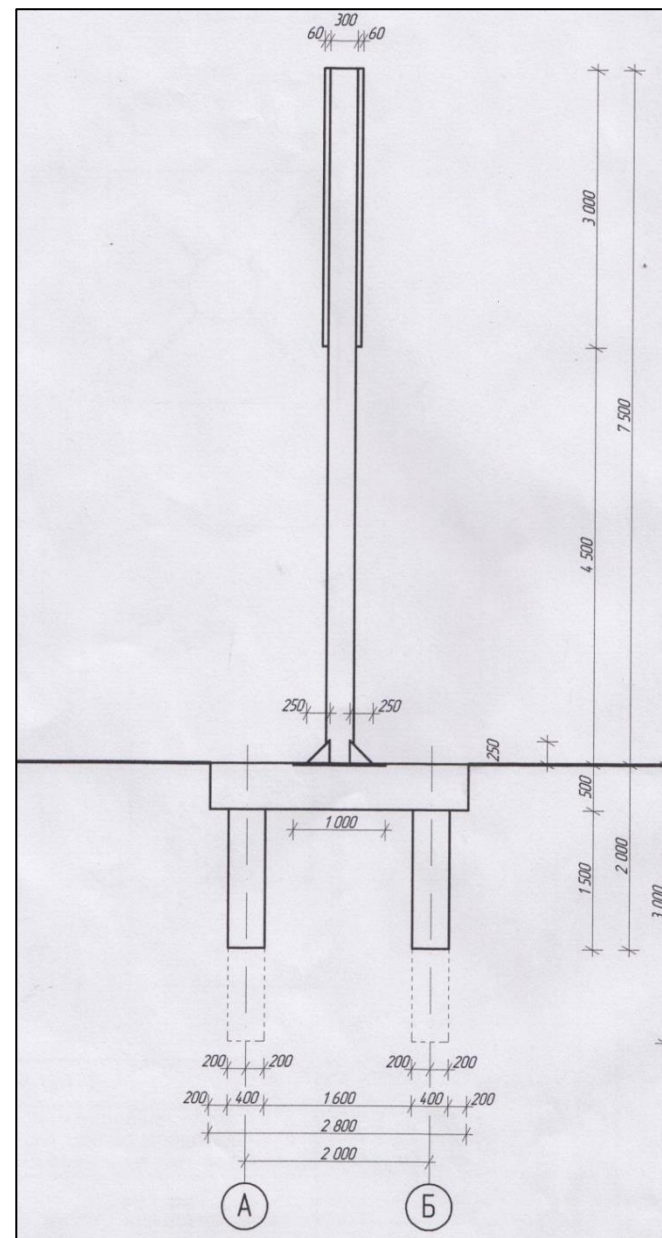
Вид и размеры рекламного щита (вид сбоку)
